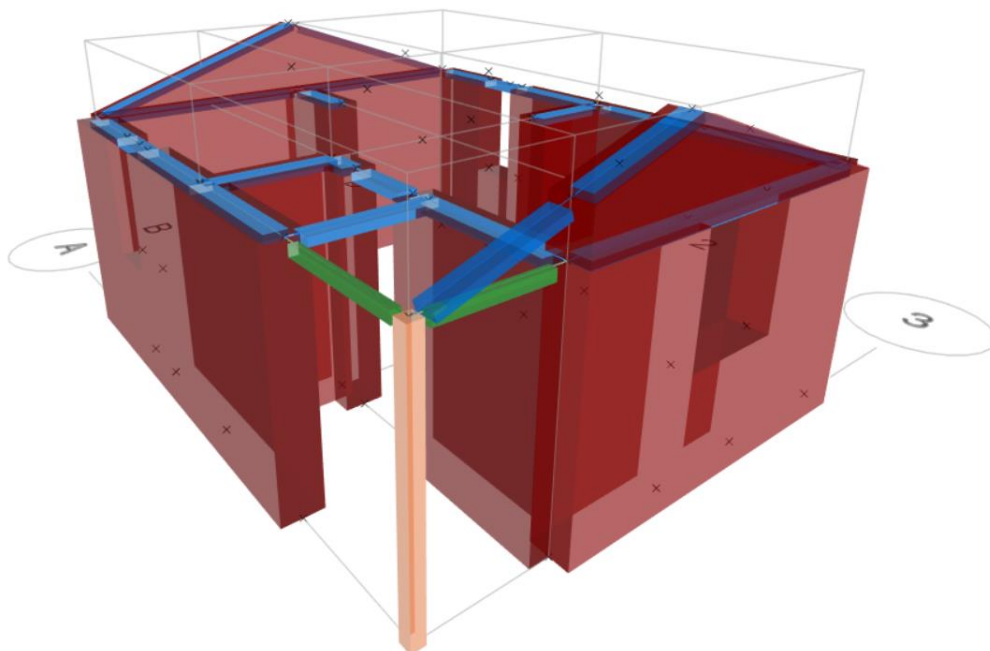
Modelamiento estructural (3D) - vivienda de adobe.
